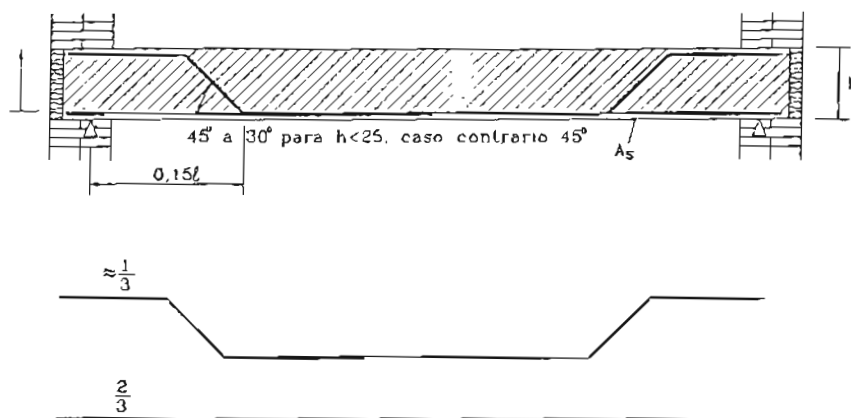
Arranjo de armadura junto ao apoio
